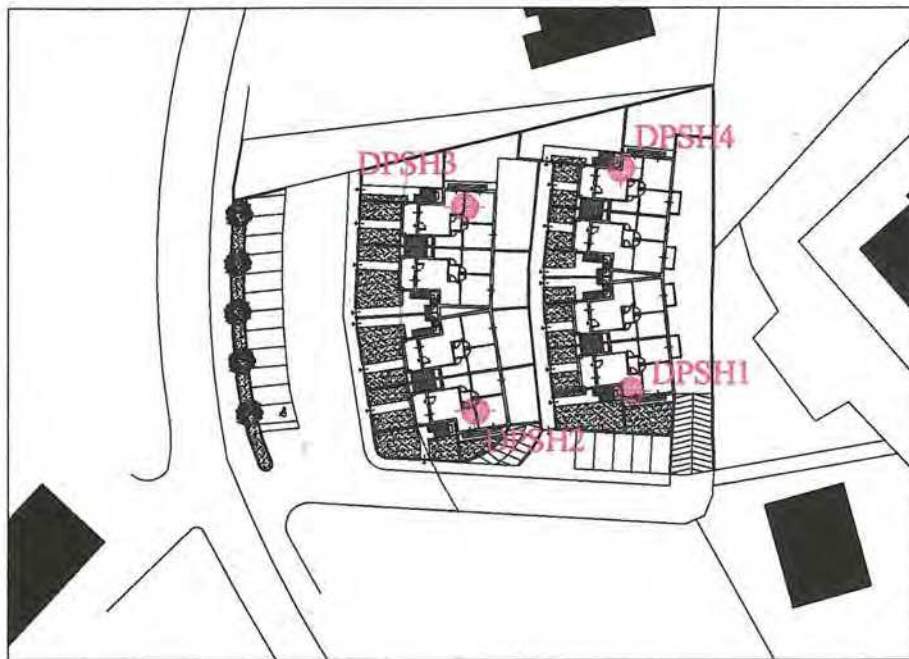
Planimetria in scala 1:1000 con l'ubicazione delle prove penetrometriche.
